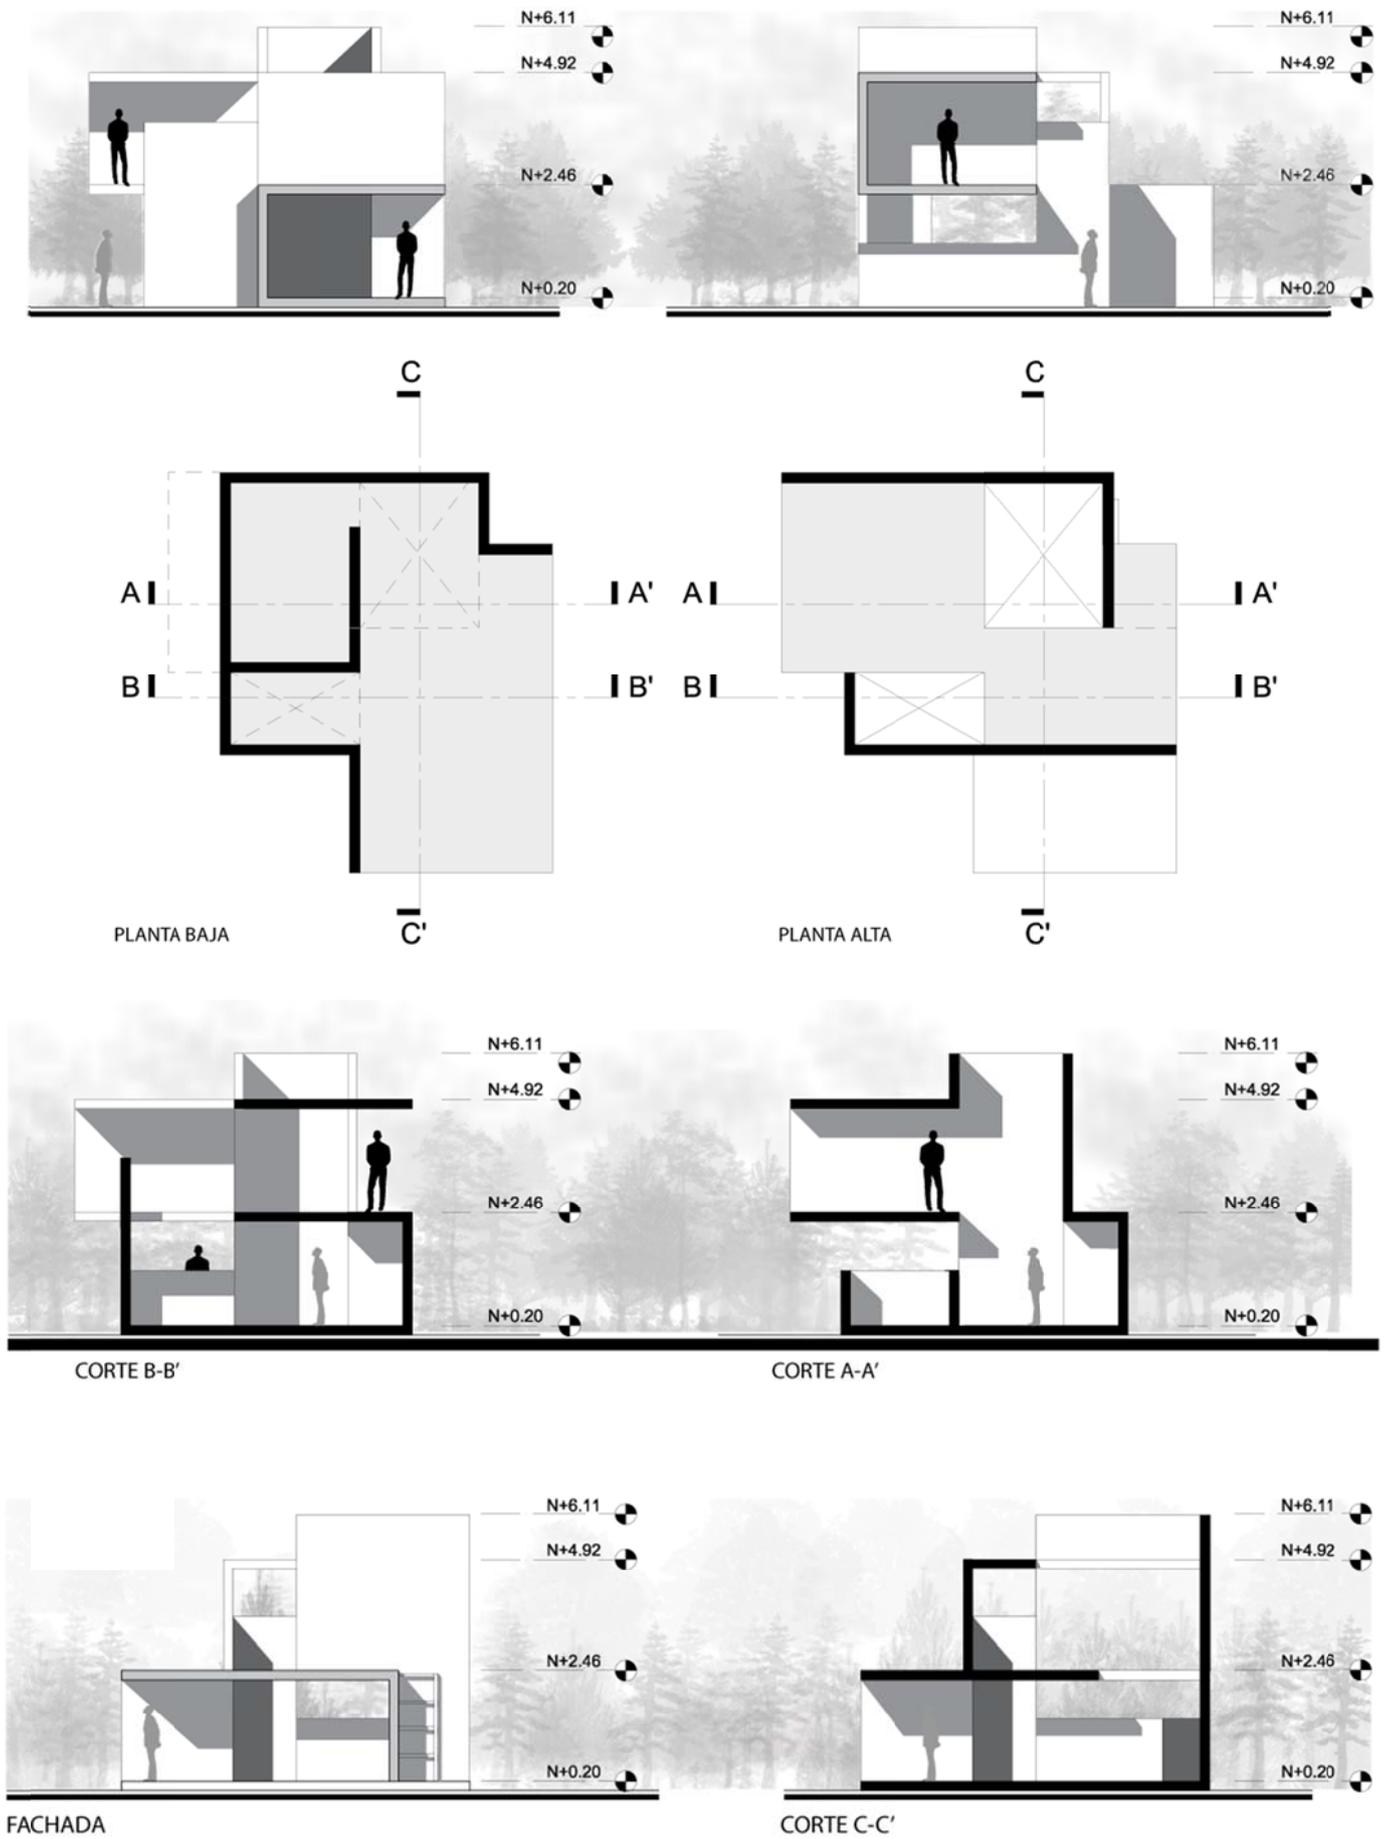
Planos Pabellón. Fuente: Elaborado por el autor
